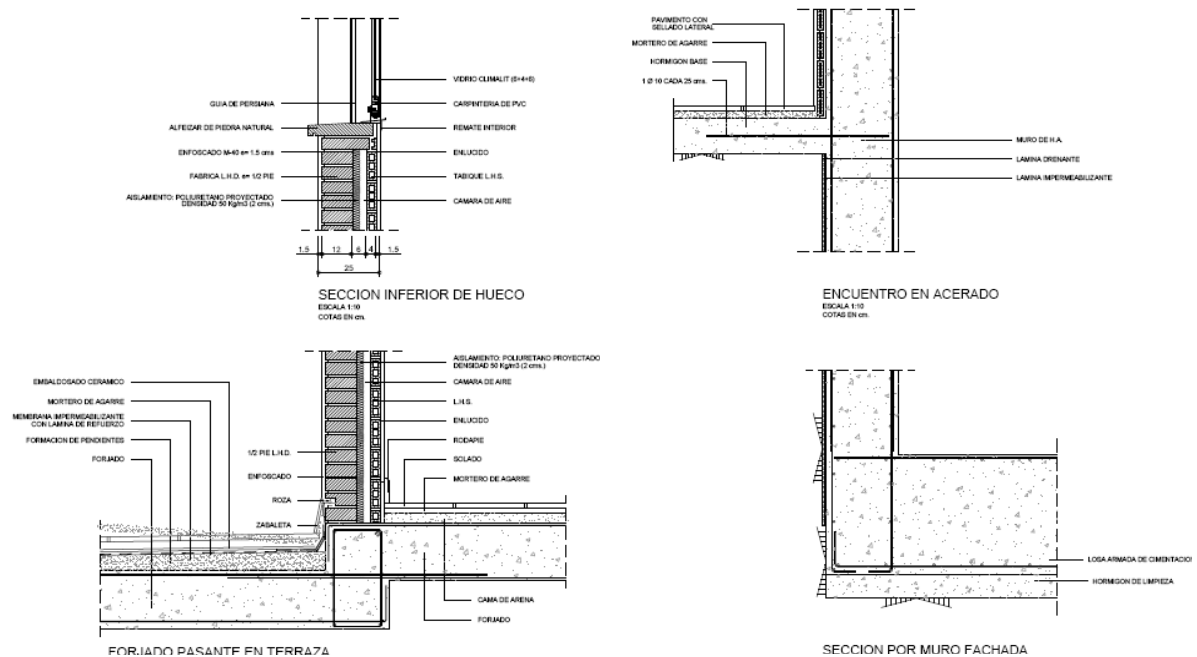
Ejemplos de detalles constructivos. Proyecto de 80 viviendas "Huerta en medio"
